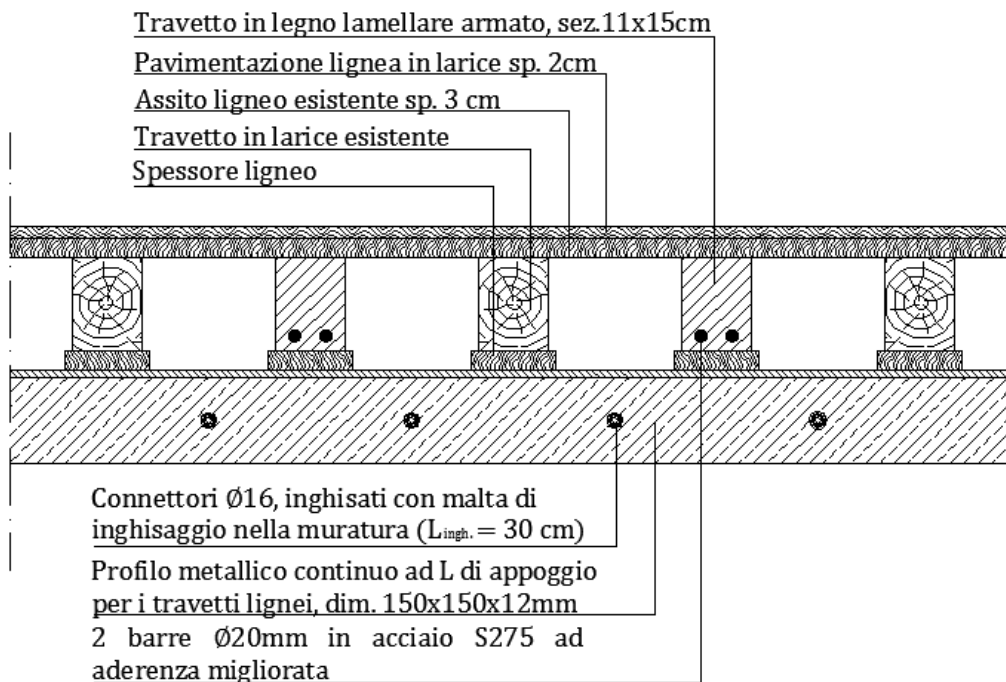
Inserimento di travetti prefabbricati in legno lamellare armato
